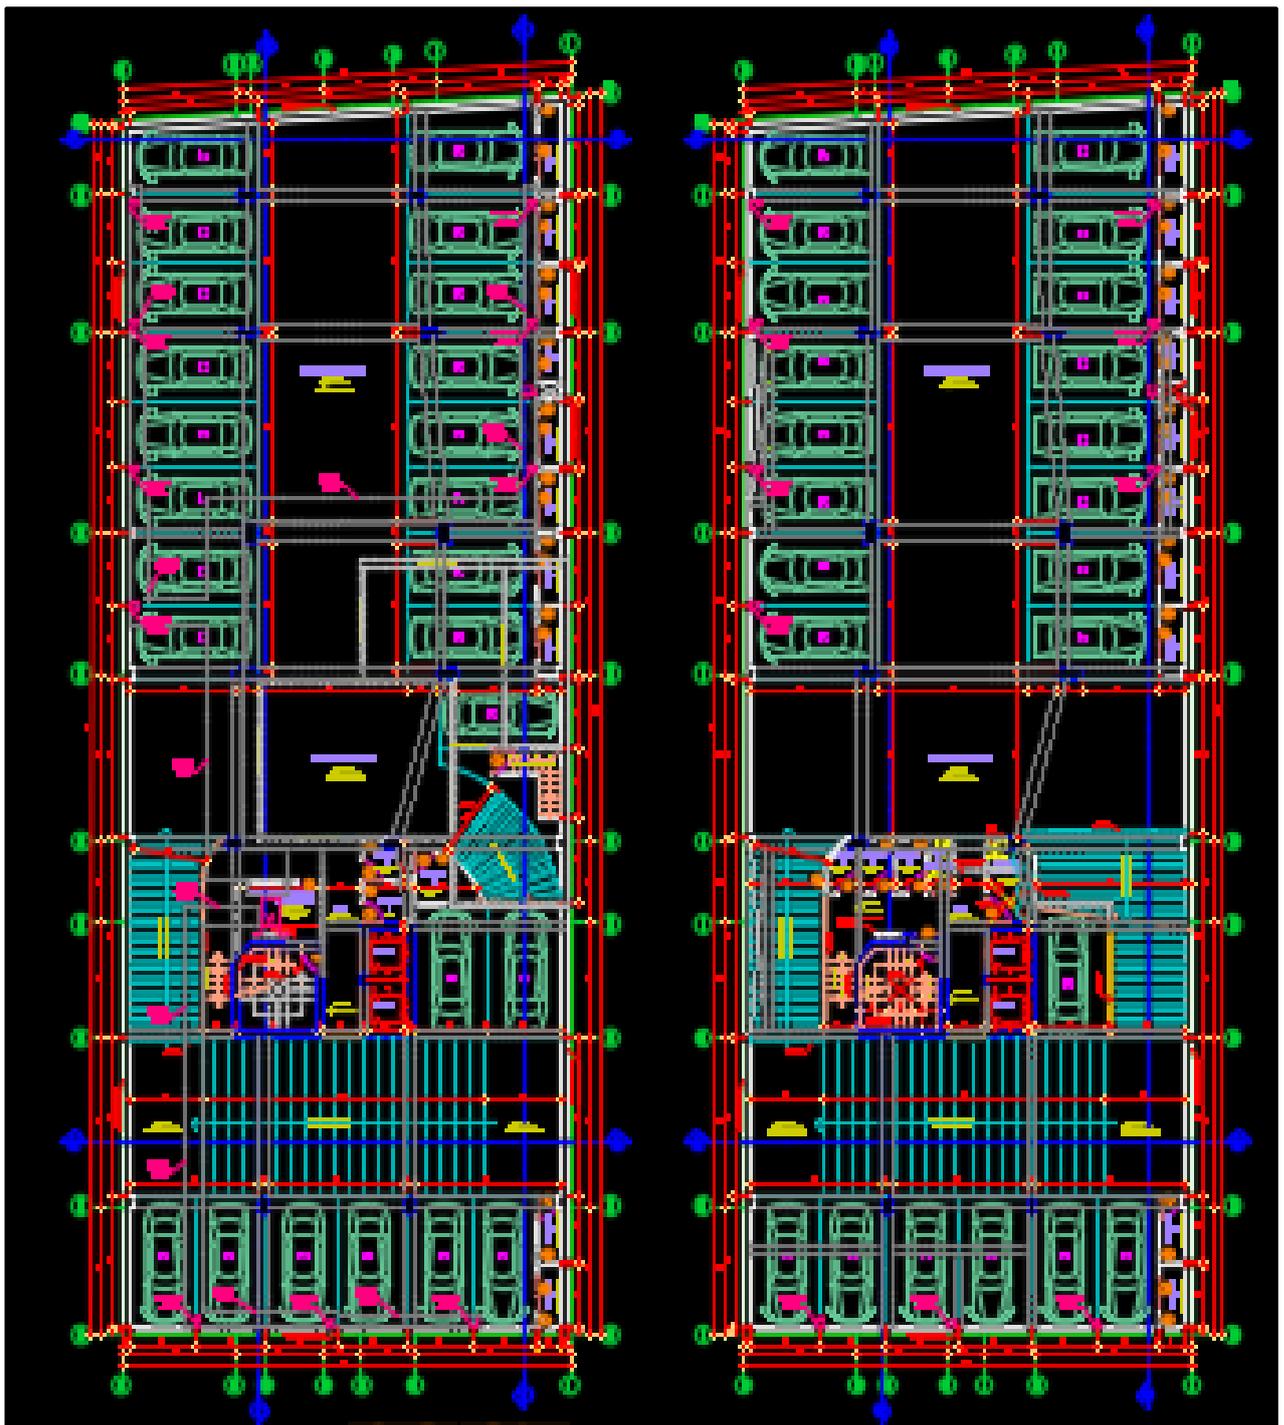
Plano de planta de sótanos 1 y 2 - Proyecto Multifamiliar
